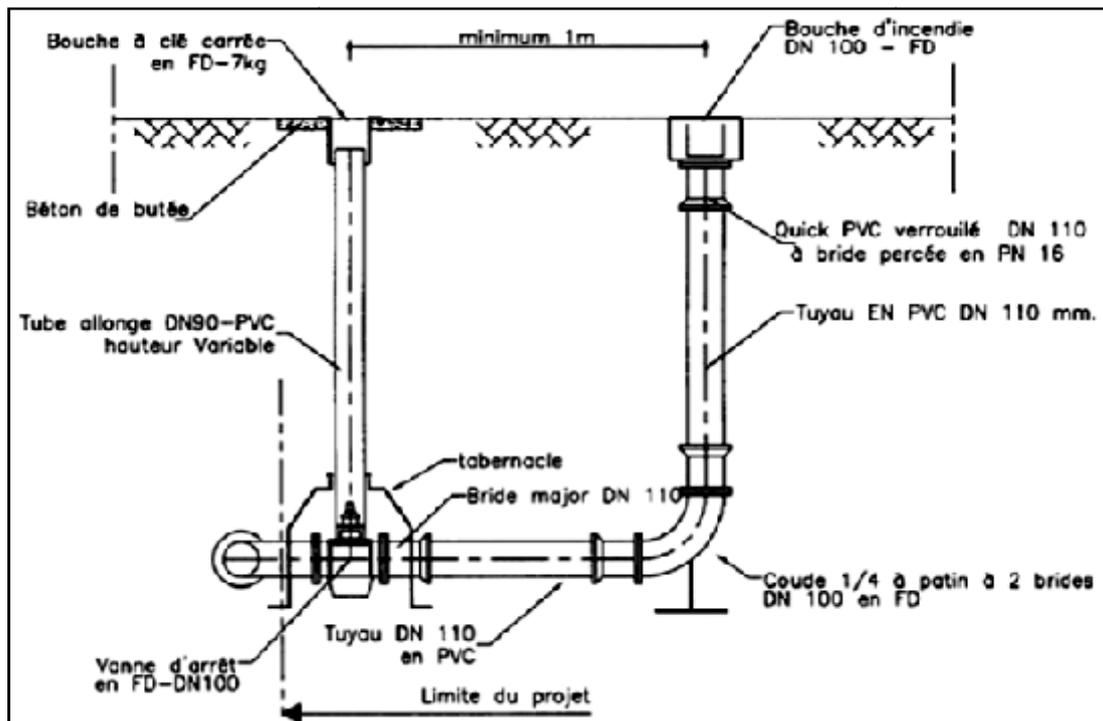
Bouche d'incendie type PAM ou similaire (coupe transversale)
